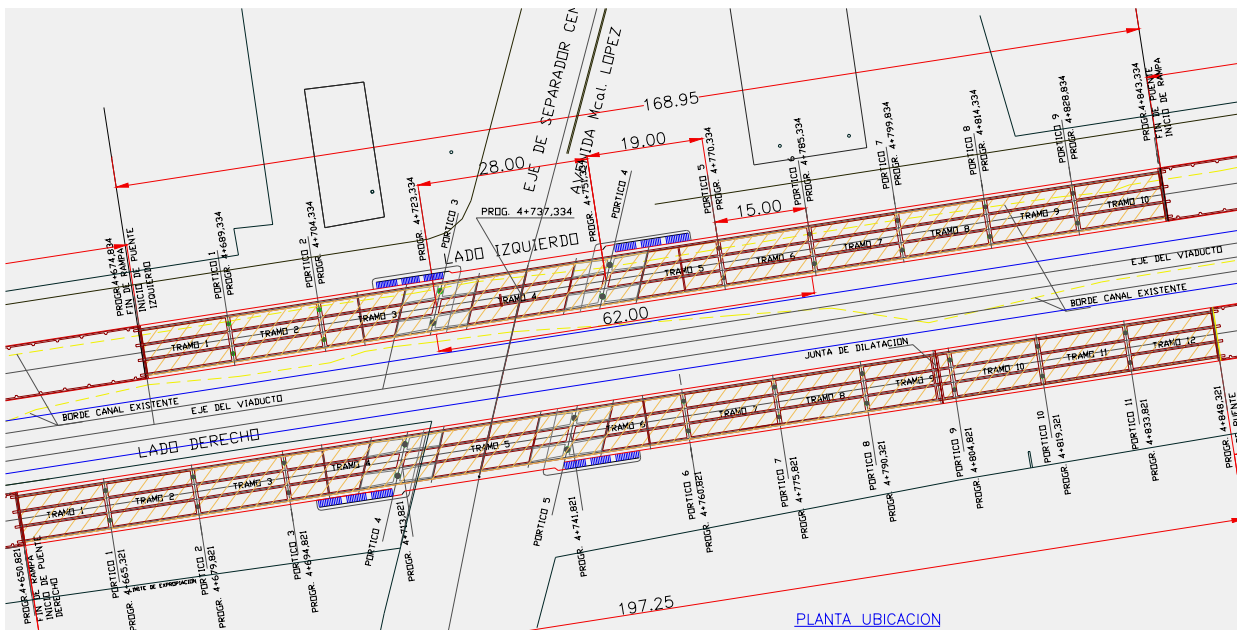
PLANTA DEL VIADUCTO IN SITU CON EL ÁREA CONSIDERADA EN EL ANALISIS.
